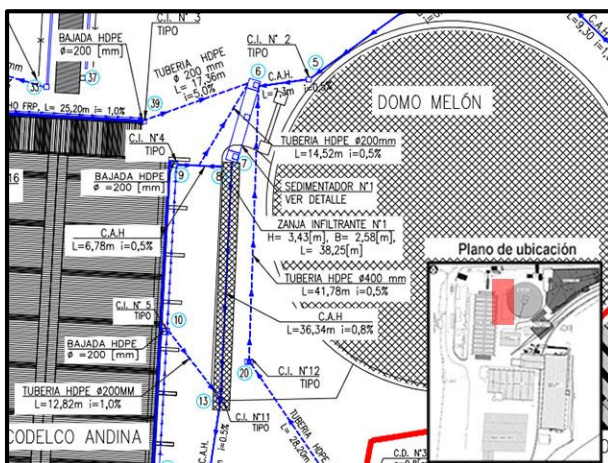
Sub áreas de drenaje sector oriente Domo Melón.
